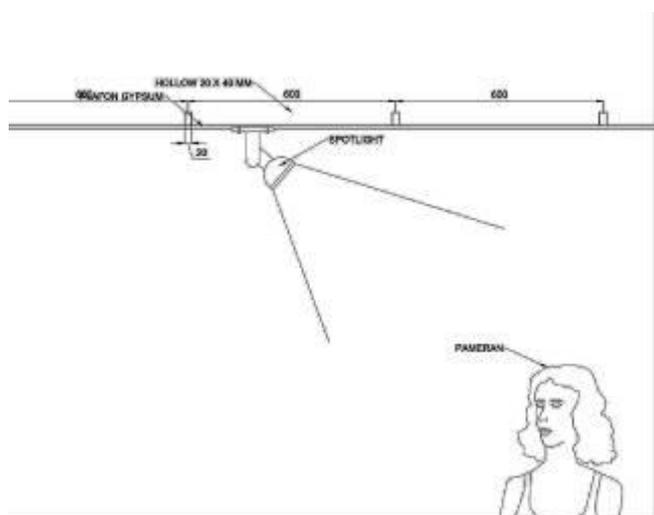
Denah dan perspektif interior Fashion Spot. Sumber: penulis
